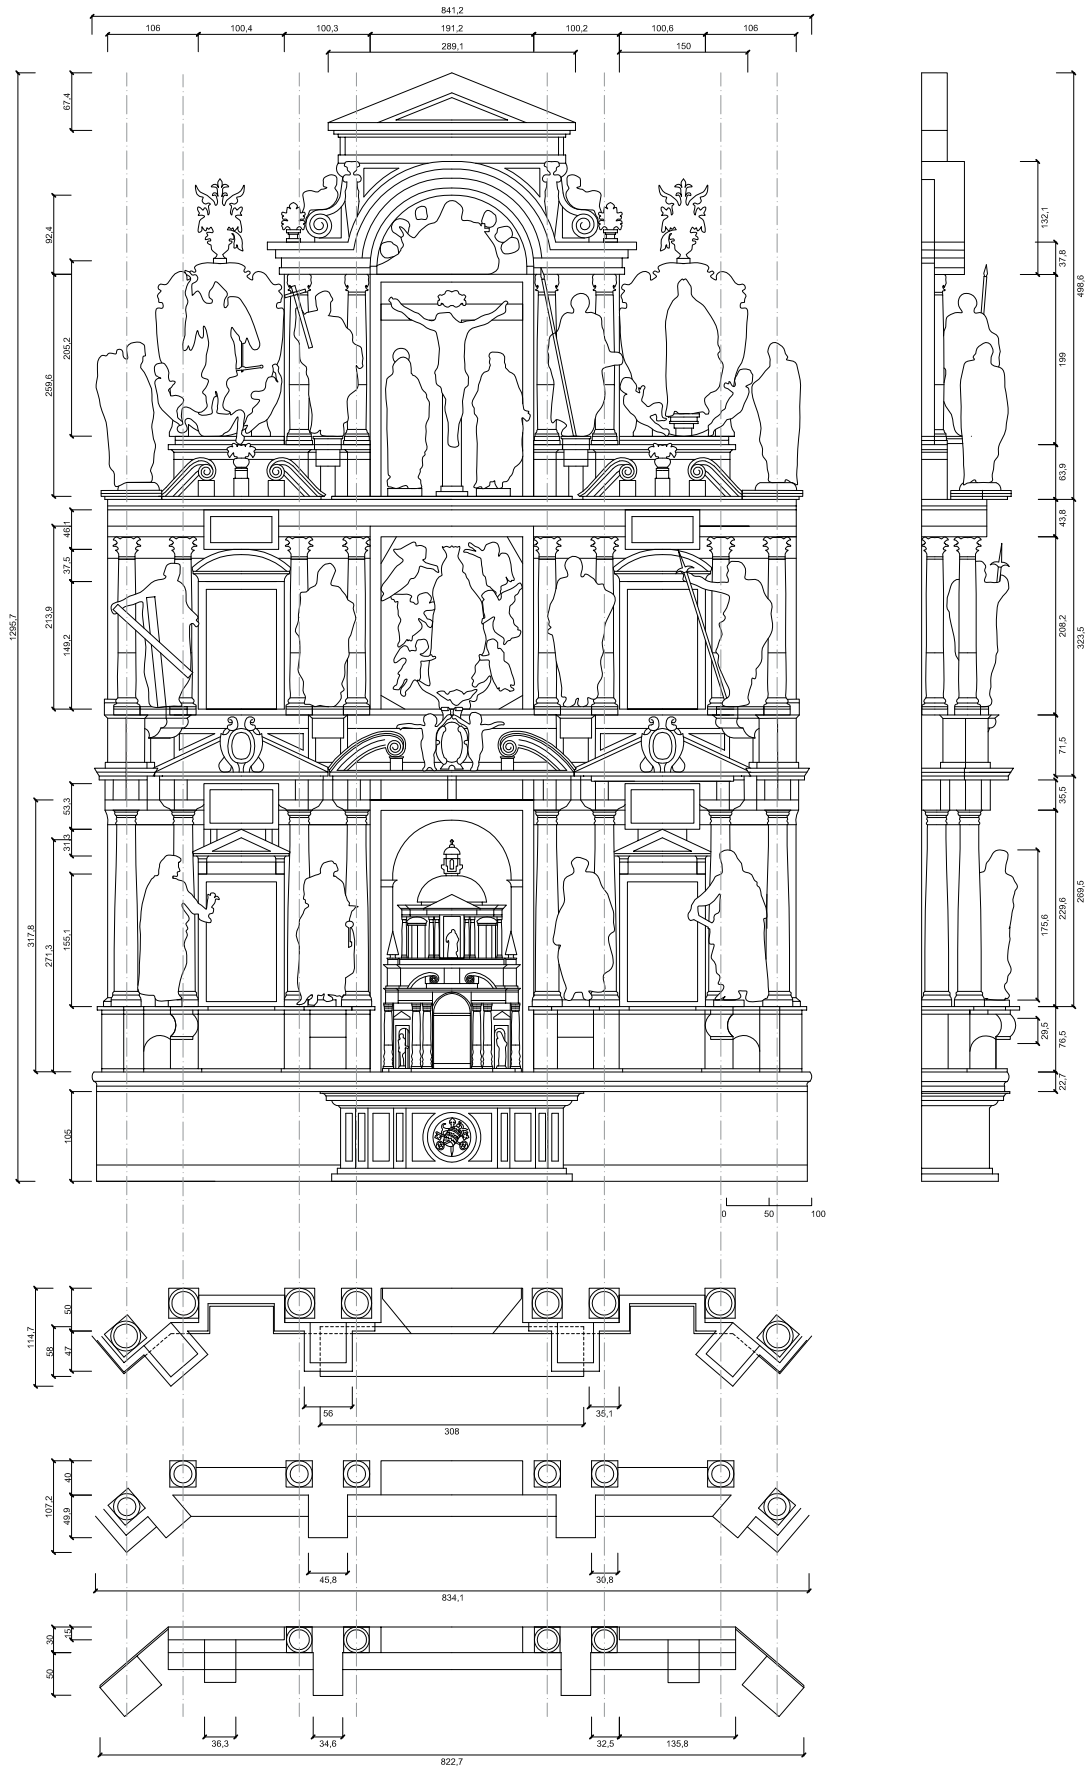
Alzado, planta y perfil del retablo (medidas en cm).
